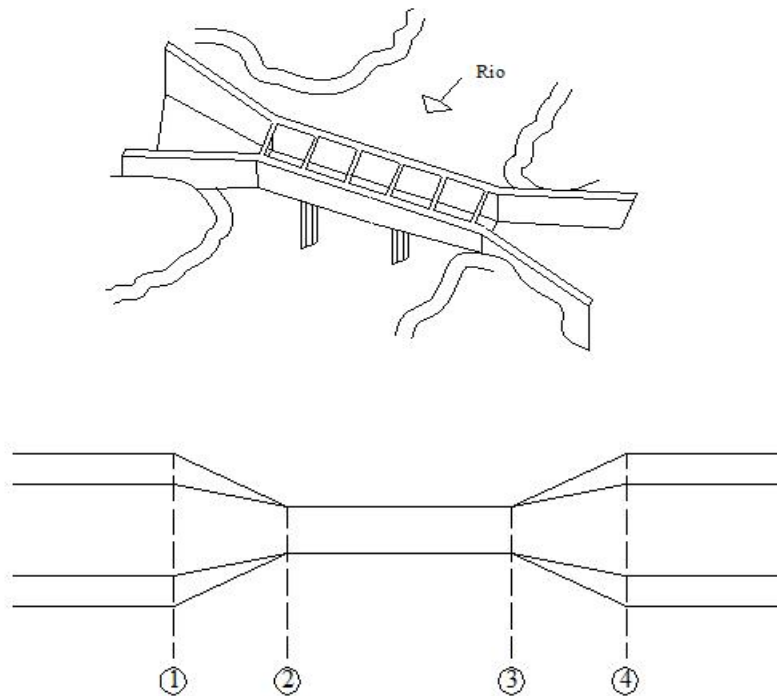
ESQUEMA DE UN PUENTE CANAL, Y VISTA EN PLANTA
